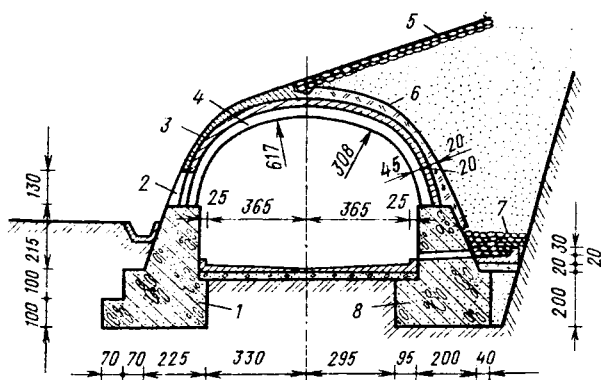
Поперечный разрез галереи «Почтовая»: 1 — опора низовая; 2 — проем для освещения; 3 — слой защитный бетонный; 4 — арка железобетонная; 5 — мощение каменное двойное; 6 — глина мятая; 7 — дренаж застенный; 8 — опора верховая
